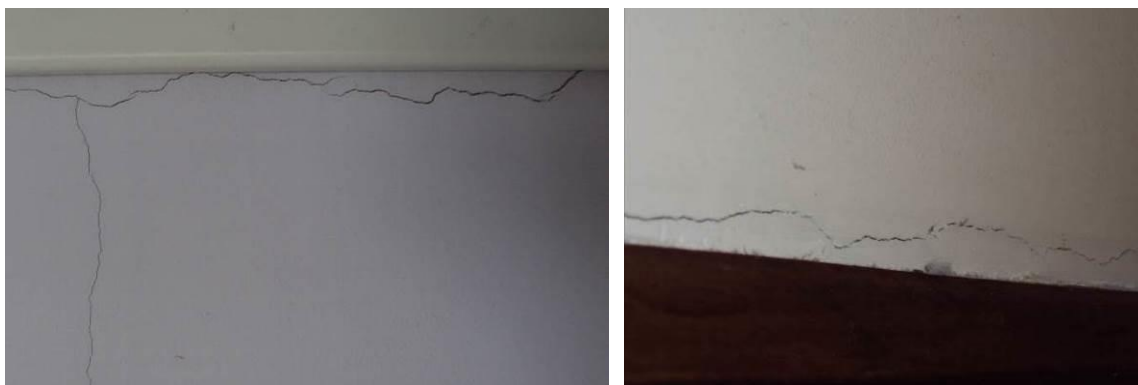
Fissuração do revestimento no piso 0 e piso 1
